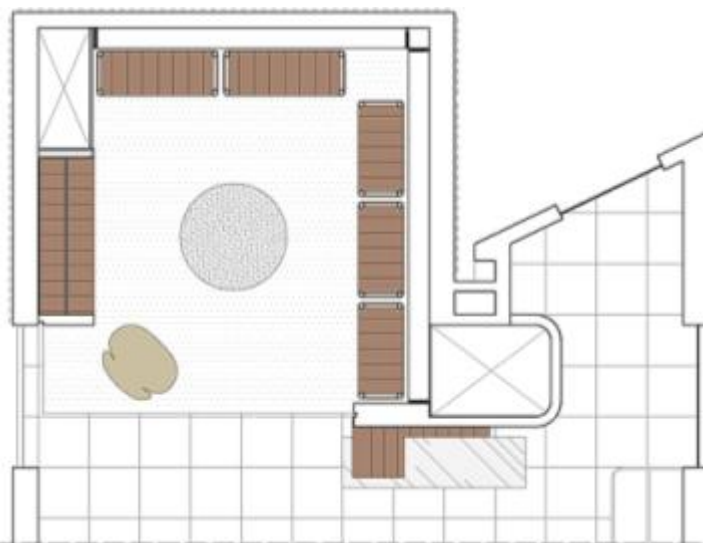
Planta baixa da Megastore de moda Dona Santa
